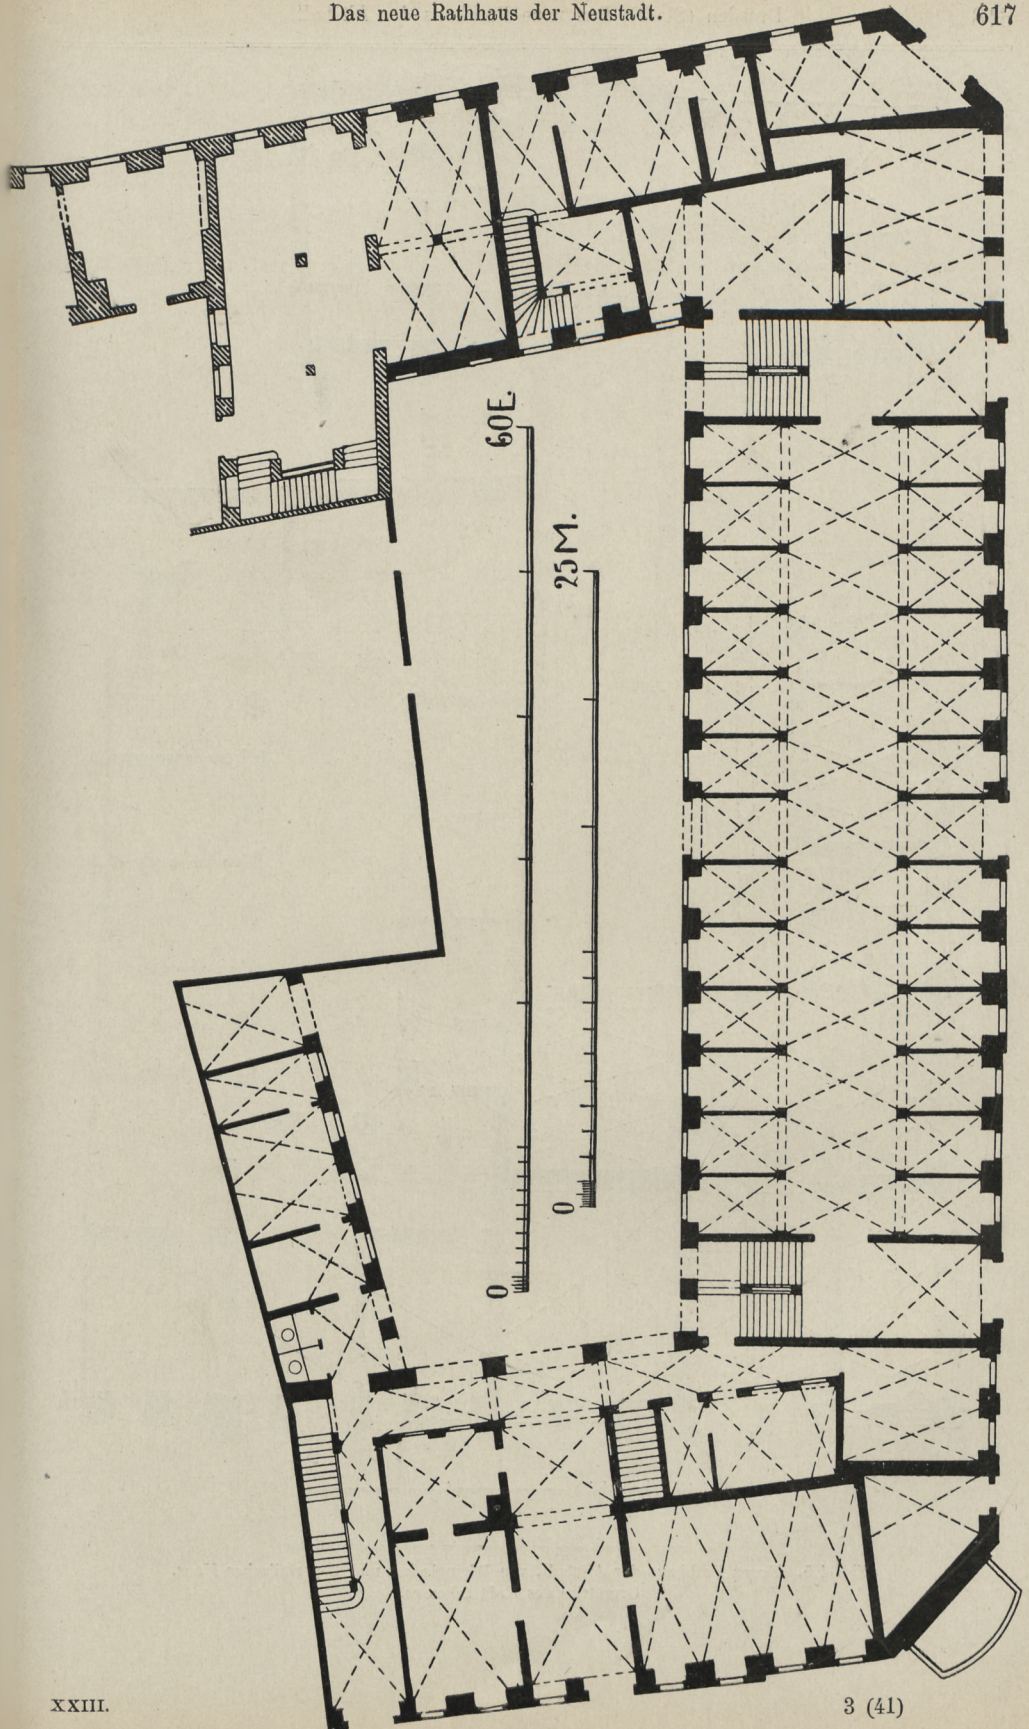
Neues Rathhaus der Neustadt. Grundriss des Erdgeschosses.
